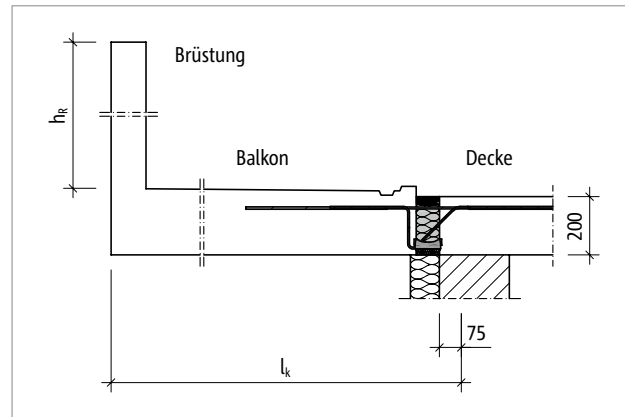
Schöck Isokorb® T Typ K: Statisches System
